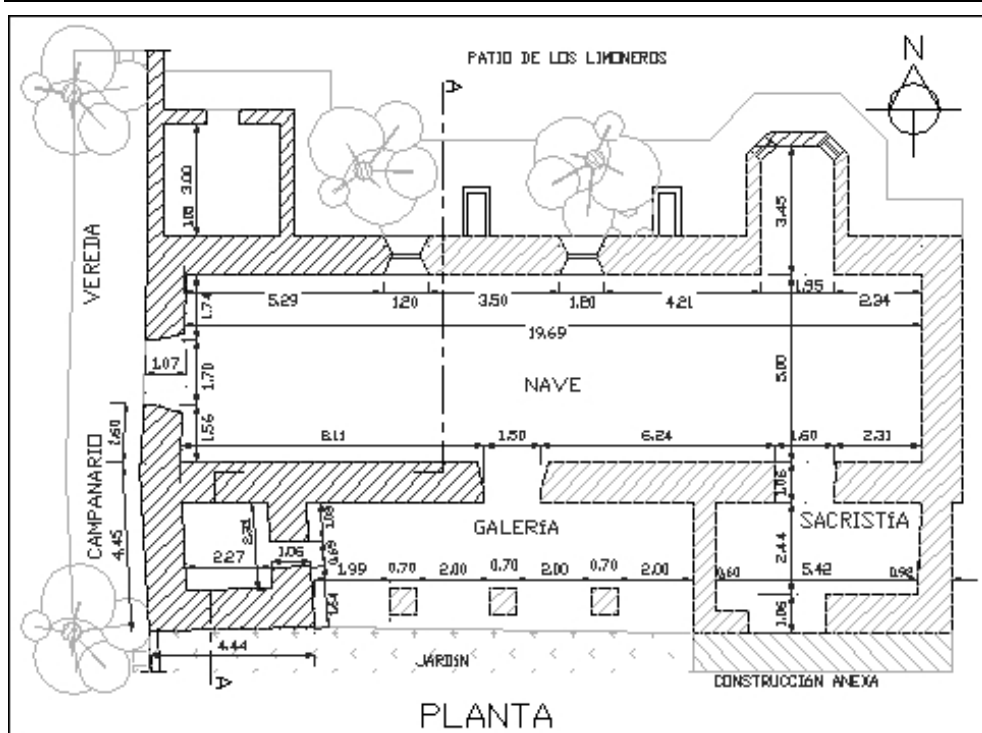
Relevamiento de la planta de la Capilla de Merlo, San Luis
